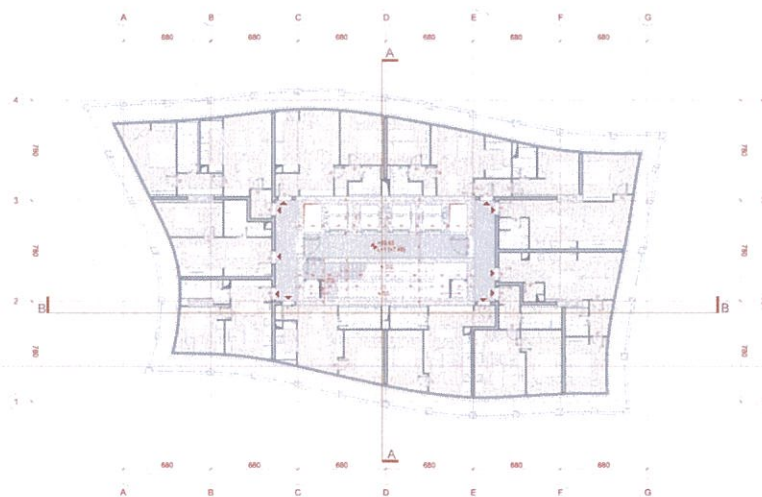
Planimetri e katit +1, në kuotën +7.48 (Tipologji e banimit 1)
